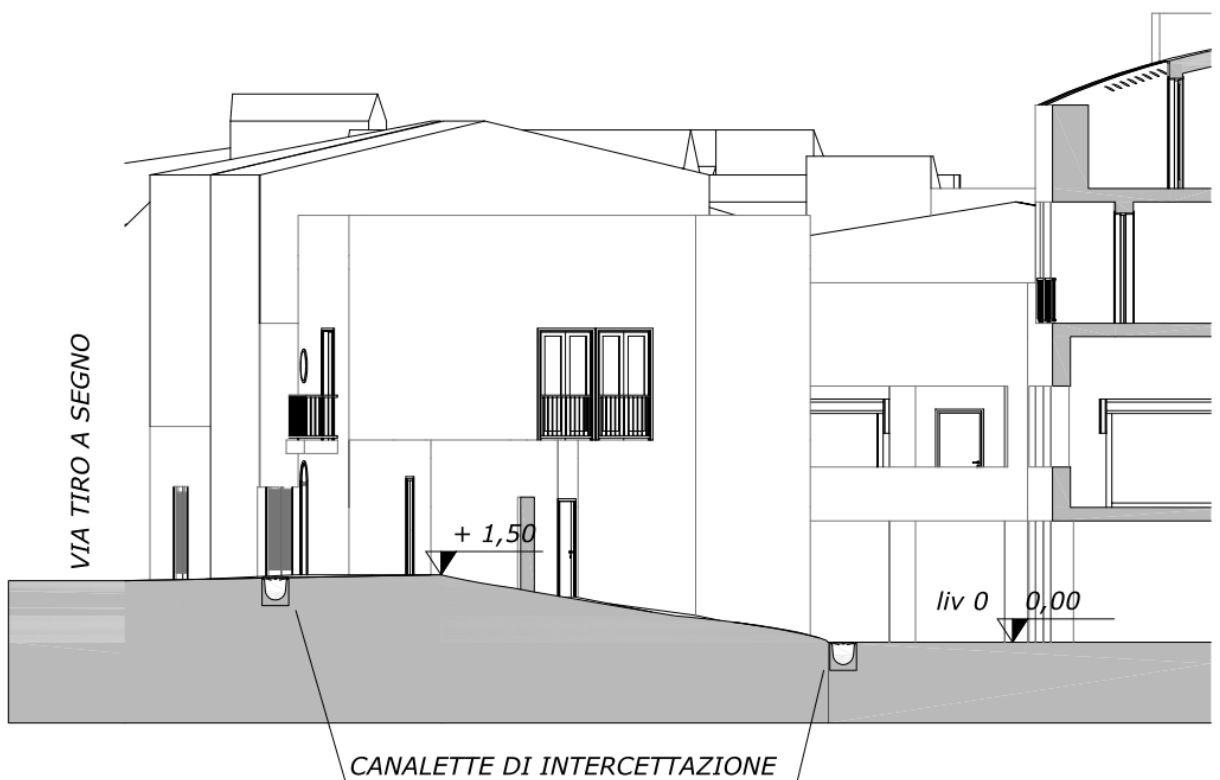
Particolare: sezione dell'ingresso di via Tiro a Segno con canalette di intercettazione
